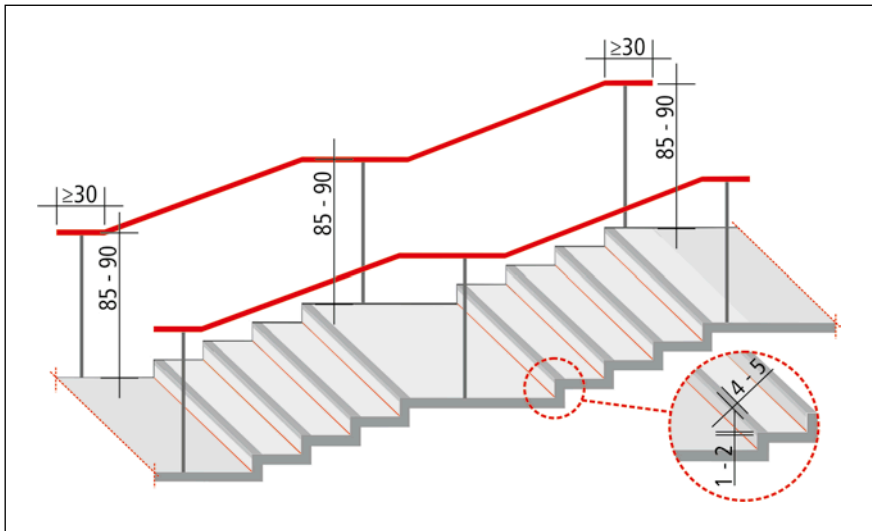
■ © Factus 2 Institut®. Schemadarstellung – Ausstattung einer barrierefreien Treppe mit beidseitigen Handläufen und Stufenmarkierung
